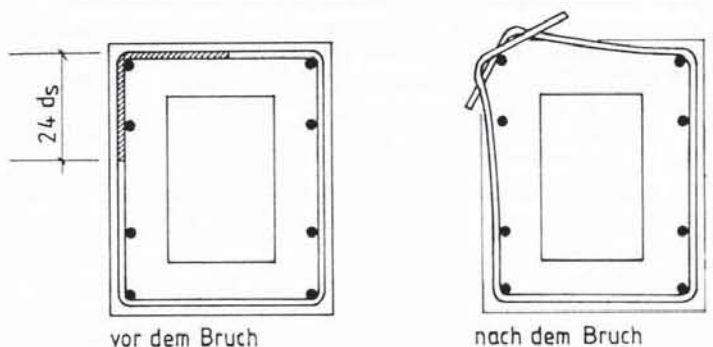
Bruchbild eines Balkens bei reiner Torsionsbeanspruchung (nach [51])
